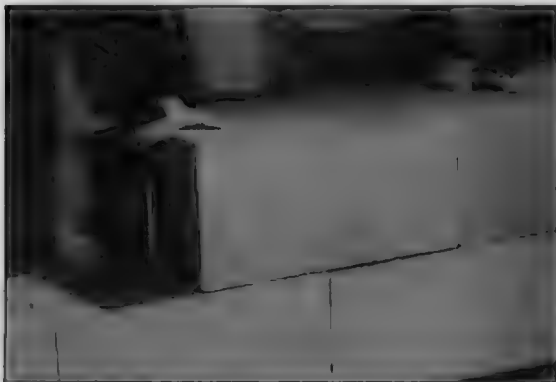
Блоки из ячеистого бетона толщиной и шириной от 5 до 37,5 см для всех наружных и внутренних стен для рациональной укладки на тонкослойный раствор «клей». Начиная с толщины в 17,5 см, в блоках могут быть паз и гребень. Благодаря этому нет необходимости в нанесении раствора на вертикальный шов
